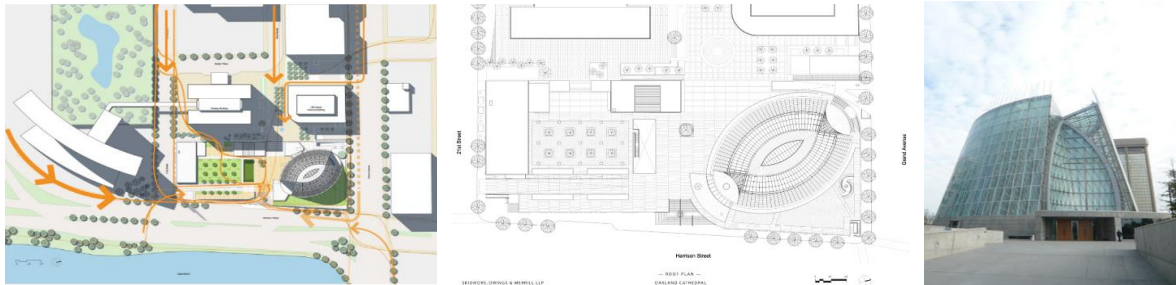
Planta de conjunto y templo. Diseño. (Hartman, 2008).
